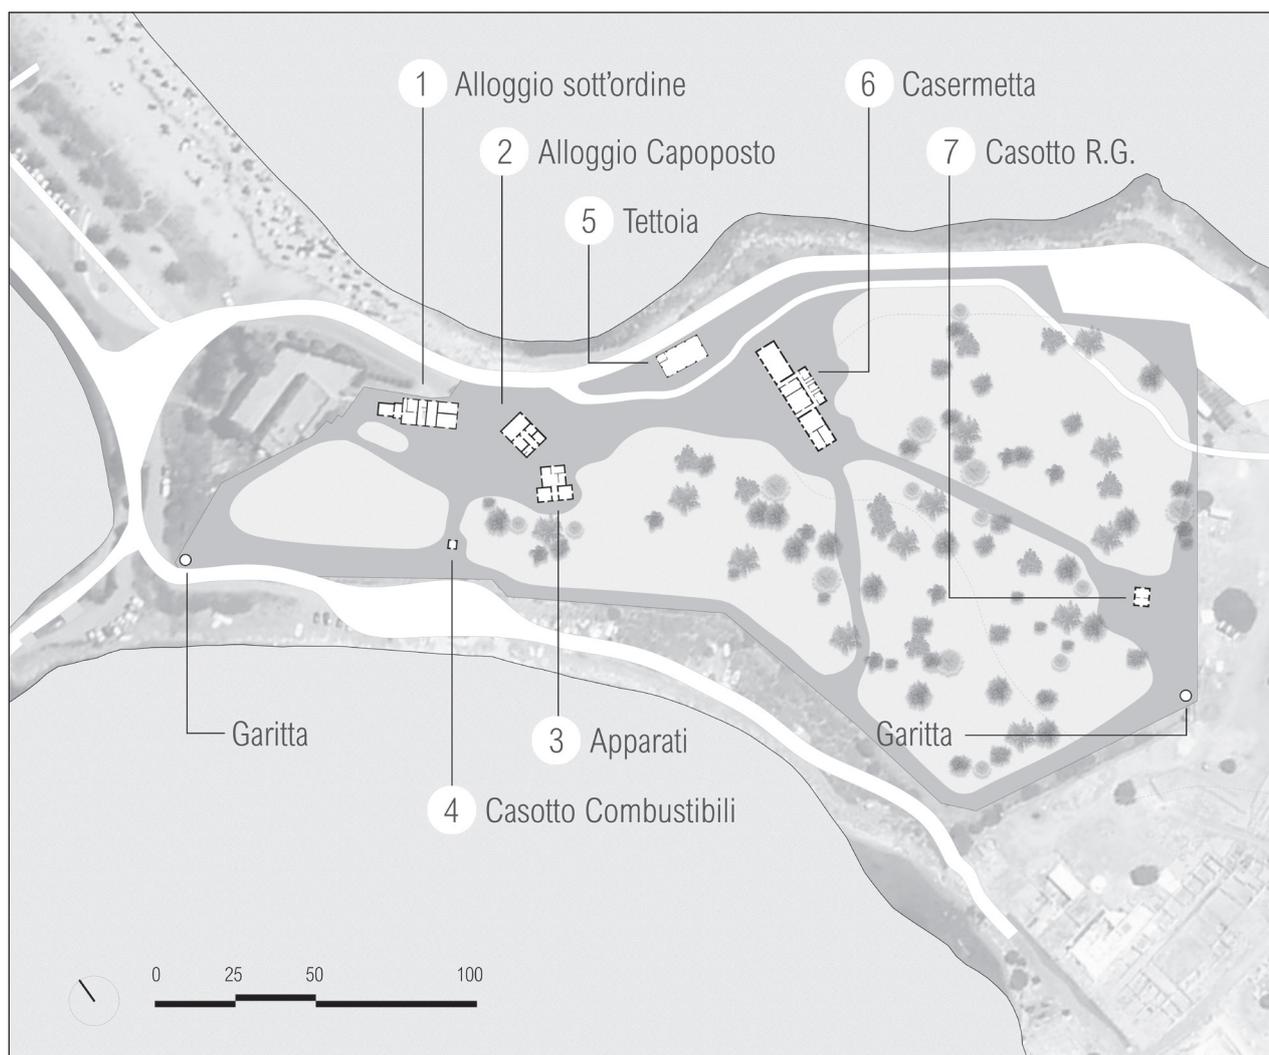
Nora, Base militare ex Stazione R.G. Planimetria dell'area con indicazione dell'uso storico dei manufatti.
